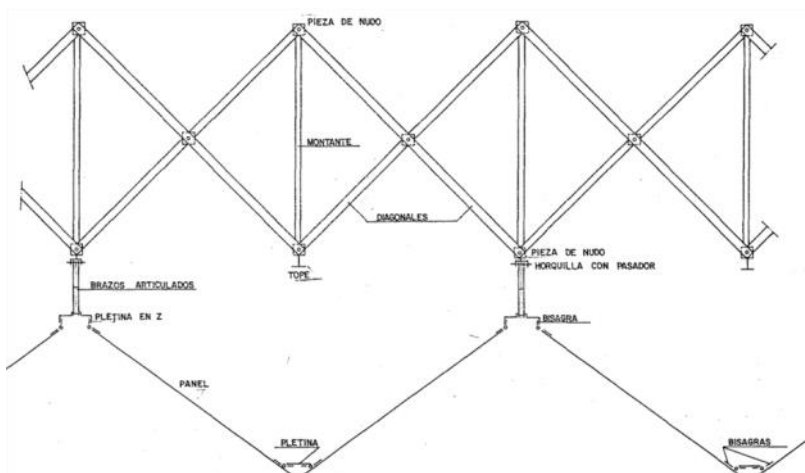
Detalle mecanismo de anclaje de estructura desplegable con paneles plegables [71]
